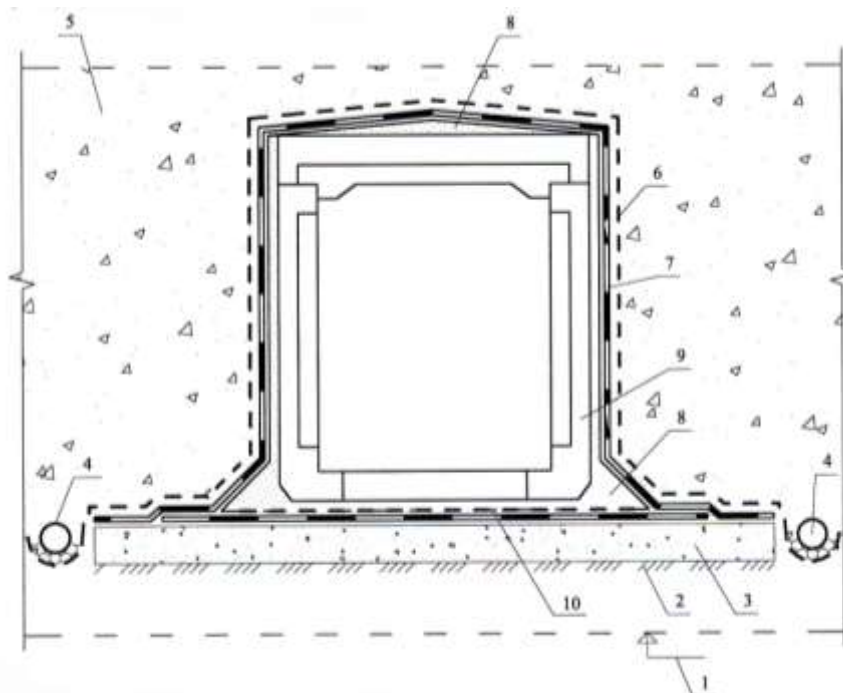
Гидроизоляция подземного сооружения от грунтовой влаги
